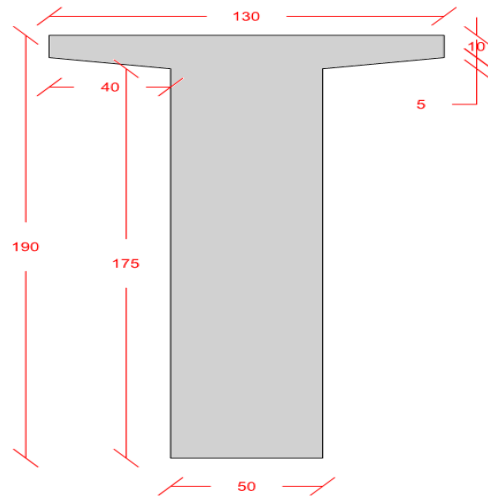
Détail de la poutre -variante 3-b (section d'about).
